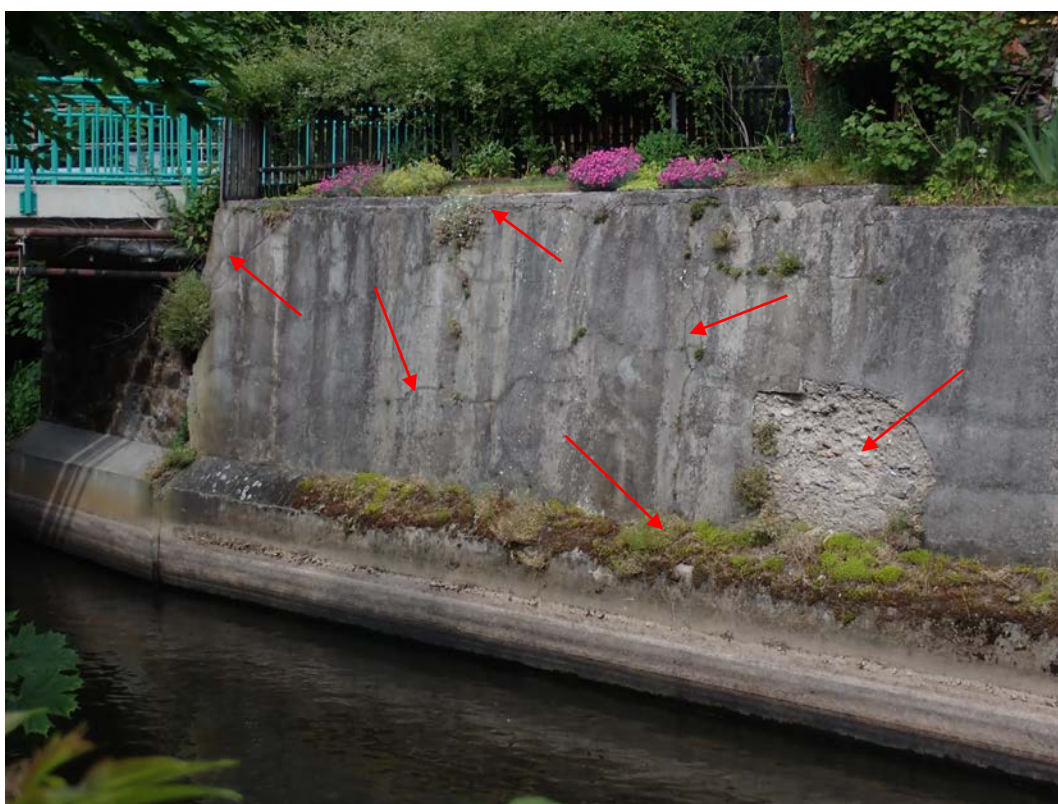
Část 4: Degradace betonu do hloubky 10 až 15 cm, trhliny ve zdivu šíře 5 až 10 mm, zed' je opatřena cementovým torkretem, v torkretu síť trhlin 2 až 5 mm. Povrch betonu degradují rostliny, mechy a lišejníky.
